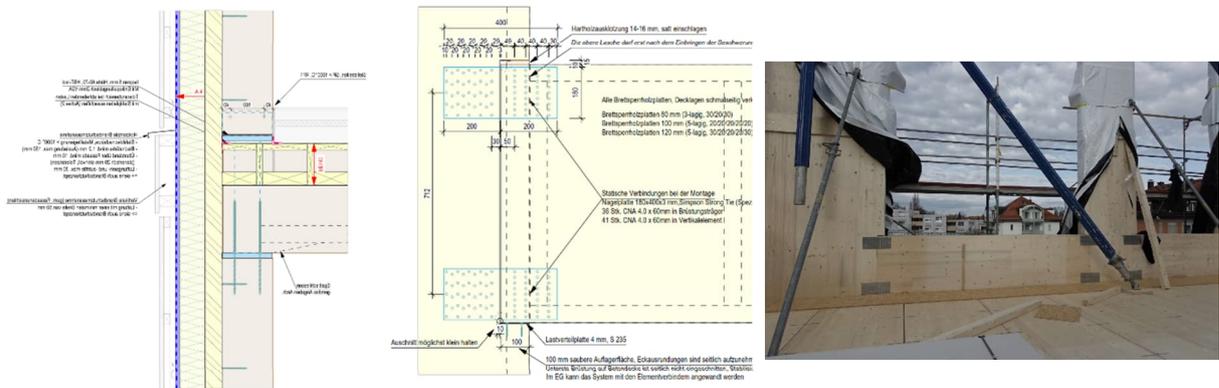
Aussenwandkonstruktion als Kombination von Holzrahmen- und Brettsperrholzbauweise (Vierendeelsystem)
